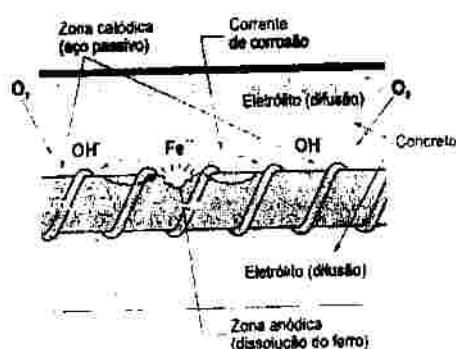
Processo corrosivo em armaduras do concreto.
